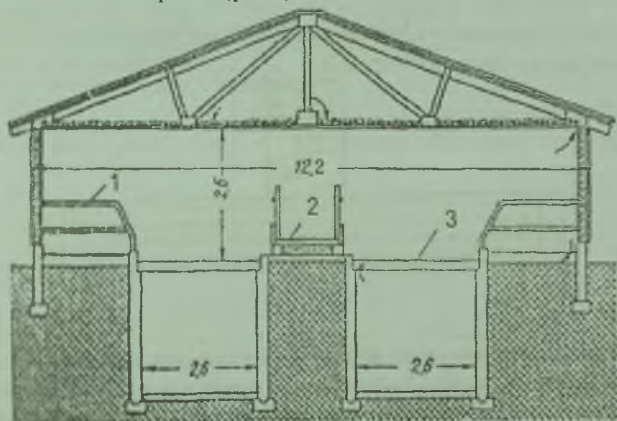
Разрез боксового коровника (размеры в м): 1 — бокс; 2 — кормовой стол; 3 — навозный проход
